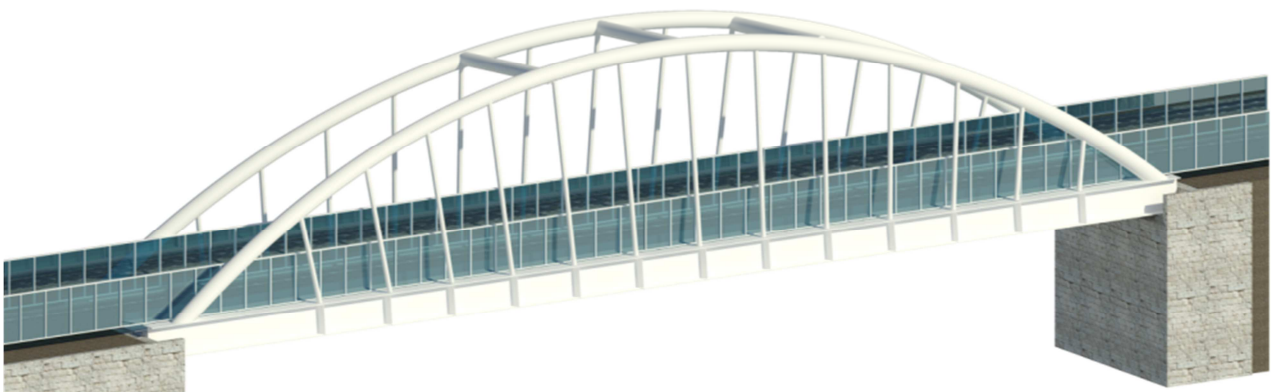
Render ponte Lamasinata soluzione come da progetto definitivo
